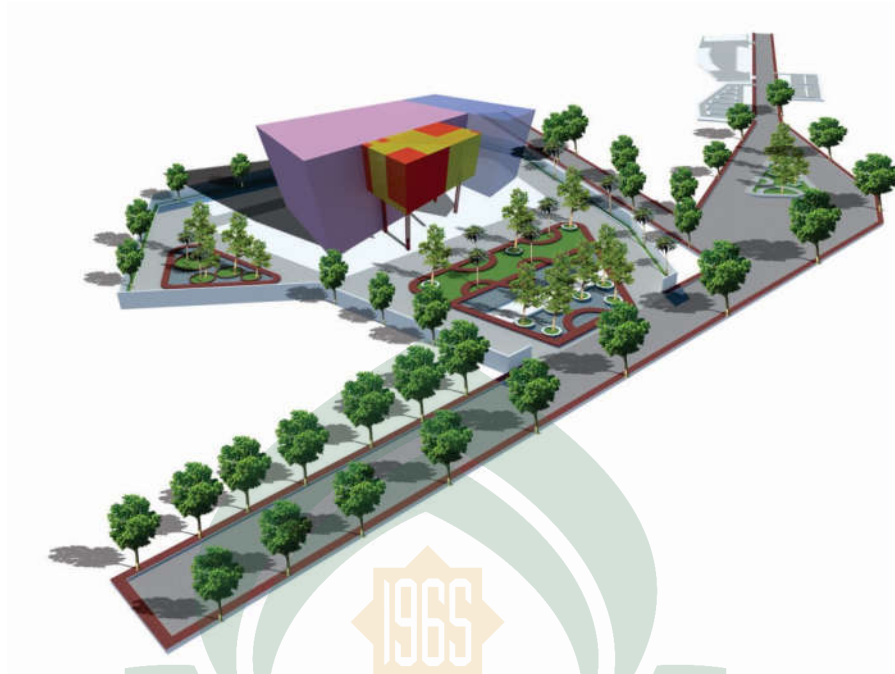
Isometri Gedung Museum Kupu – Kupu Bantimurung
